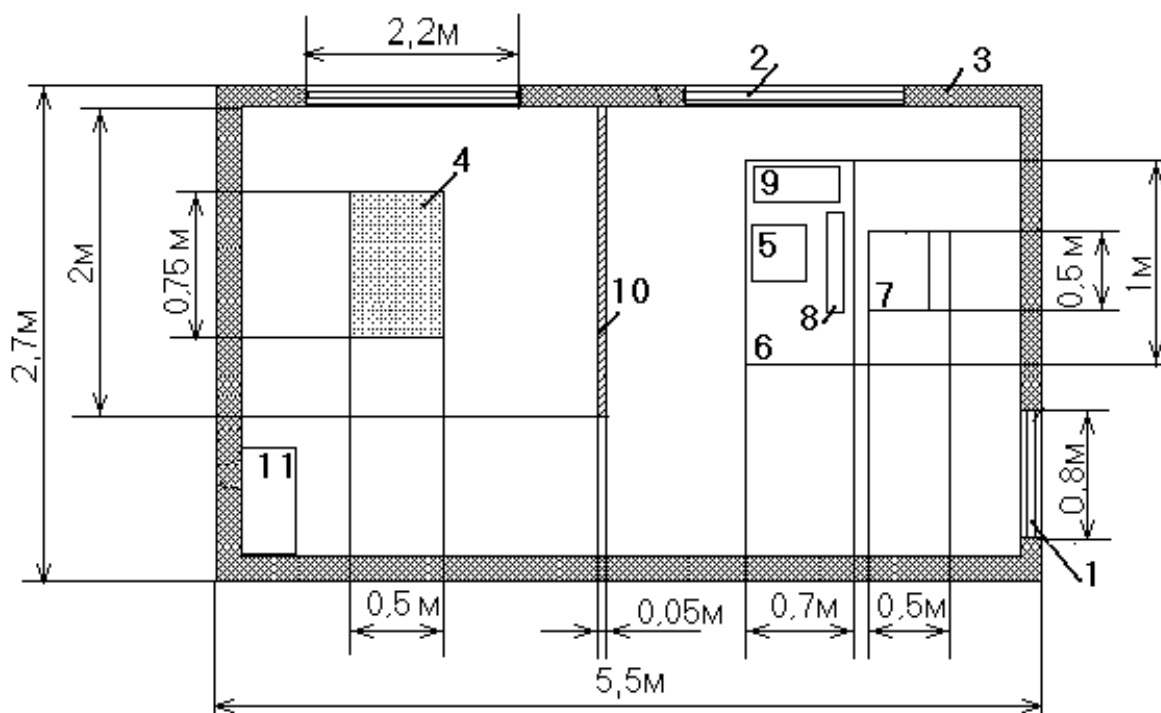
План здания (1 – помещение узла; 2 – дверь; 3 – окно; 4 – стена).
